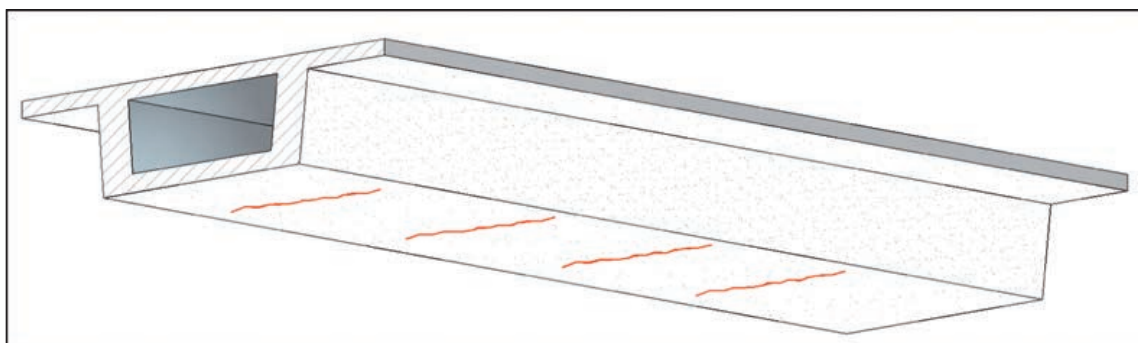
FISURAS TRANSVERSALES POR CONTRACCIÓN TÉRMICA DIFERENCIAL ENTRE LA LOSA INFERIOR DELGADA, QUE SE ENFRÍA MÁS RÁPIDAMENTE QUE LAS ALMAS MÁS GRUESAS.
